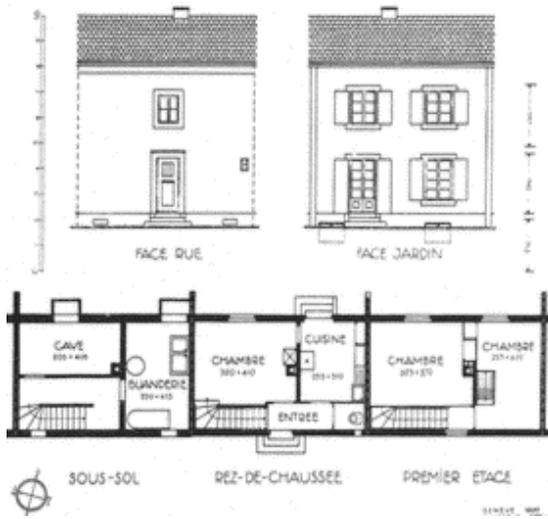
Façade et plan d'un logement de la Cité-Jardin
